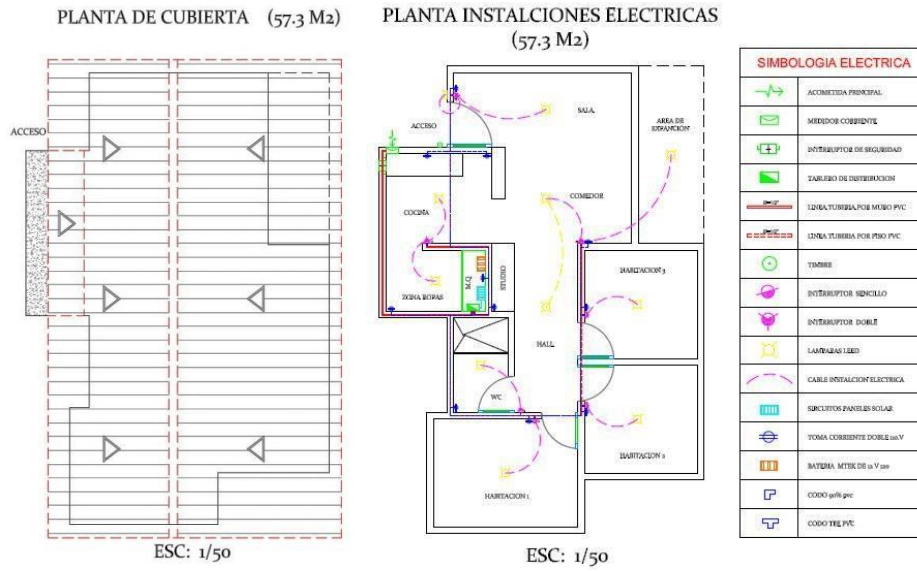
Planta de Cubierta e Instalaciones Eléctricas
